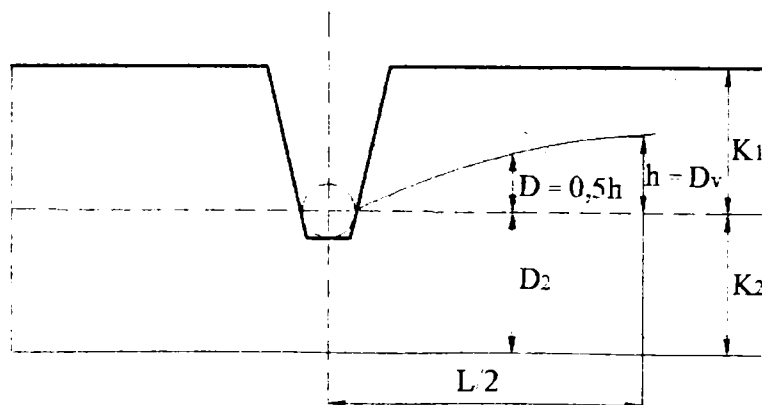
Elementele de calcul ale drenajului când planul de separare a solurilor intersectează drenul
